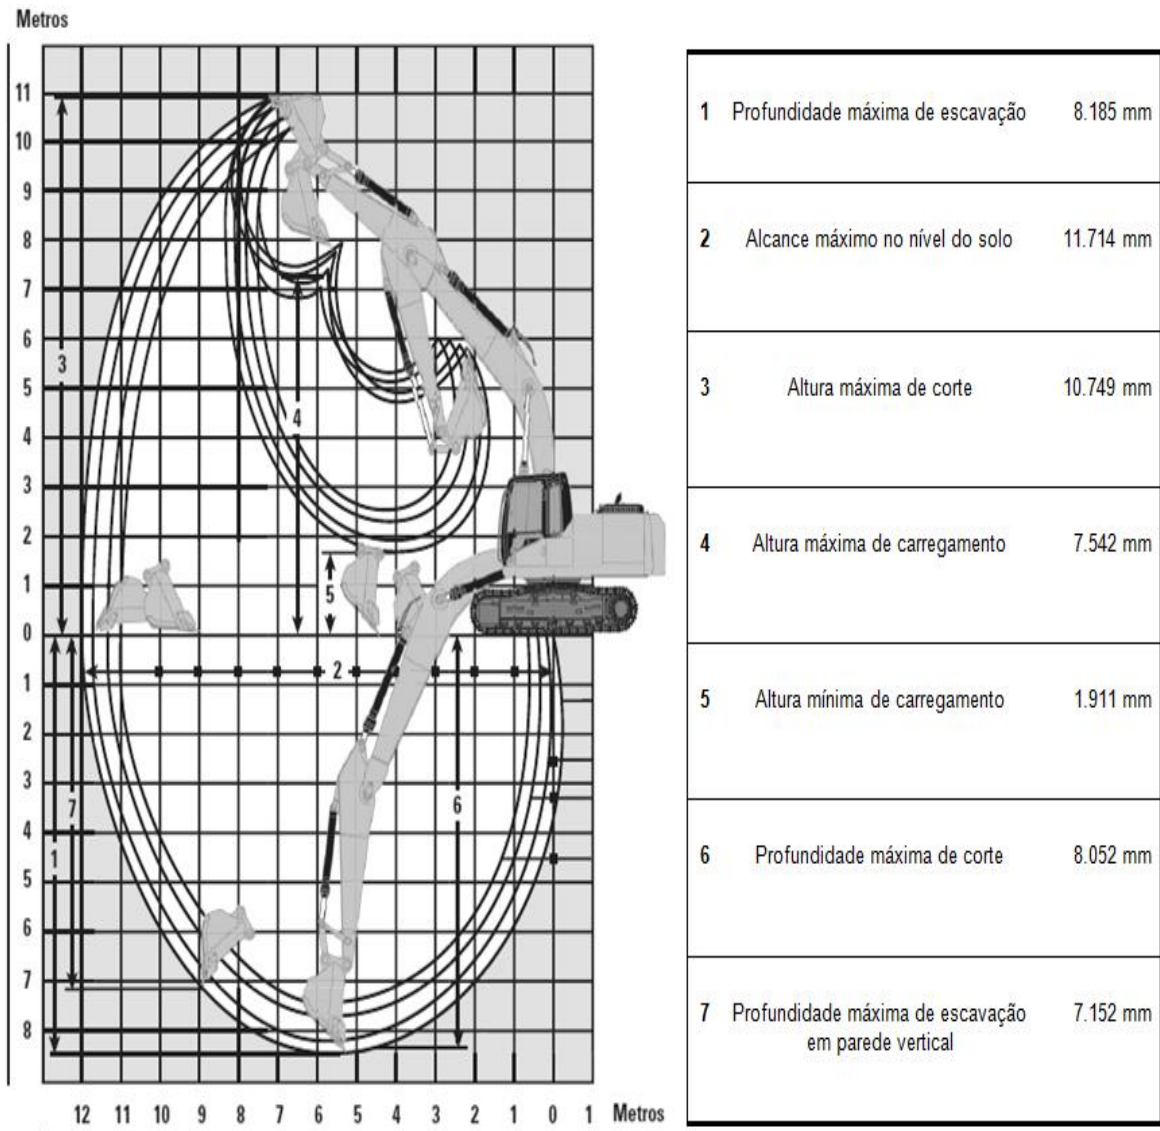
Faixas de trabalho da escavadeira, conforme fabricante original.
